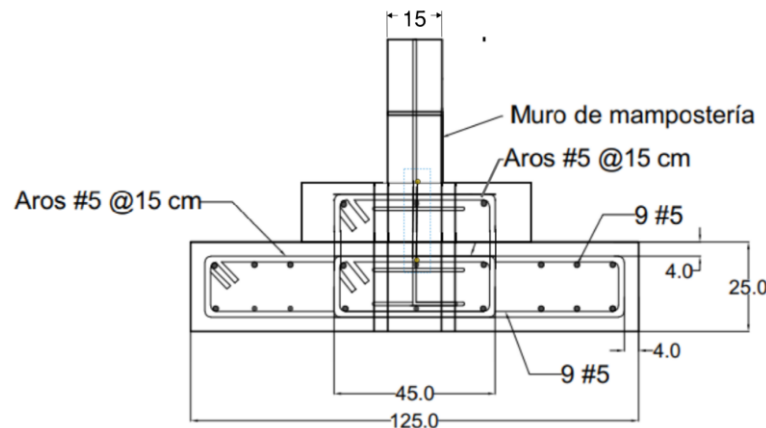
Detalle de refuerzo en cimiento de concreto.
